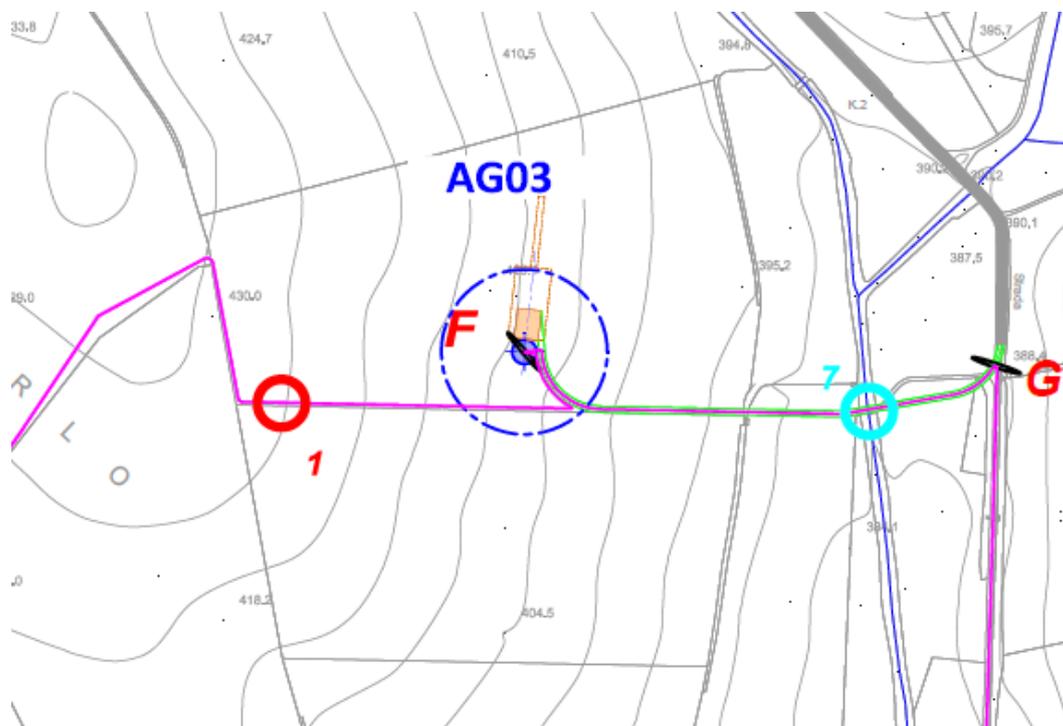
Estratto elaborato SPN_2.5C - Planimetria Linea Elettrica su CTR - Pianta e Sezioni
